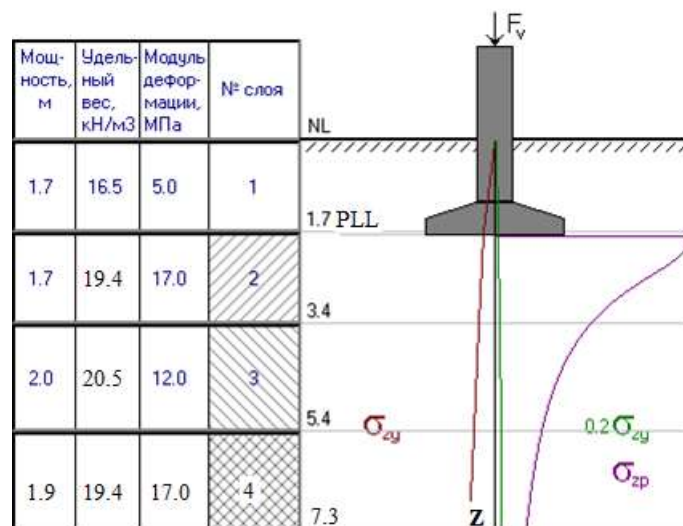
Расчётная схема к определению осадки по методу послойного суммирования для ленточного фундамента на естественном основании, до его дополнительного нагружения в результате реконструкции
